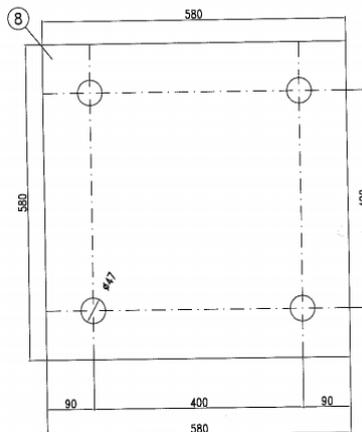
Piastra e disposizione tirafondi LSU18a
